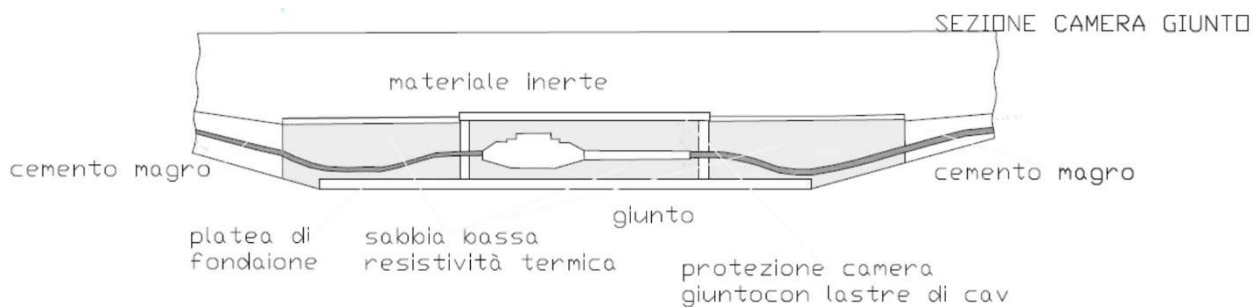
Sezione camera giunto Cavidotto di connessione 36 kV con la stazione RTN 380/150/36 KV
